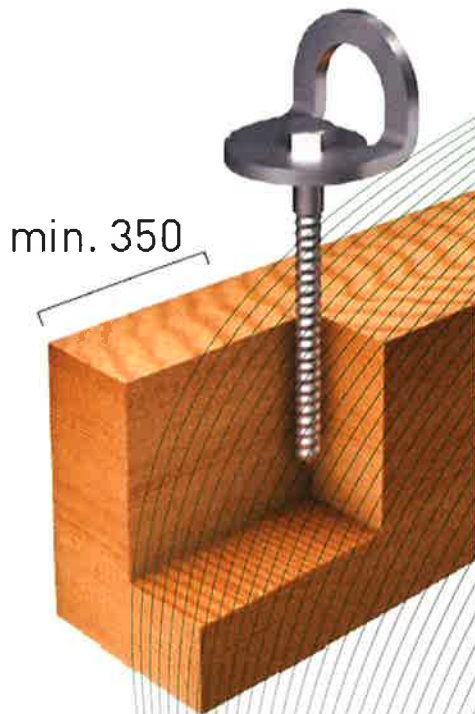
Anschlageinrichtung Typ A, Typ: EAP 0 (Montagebeispiel)
